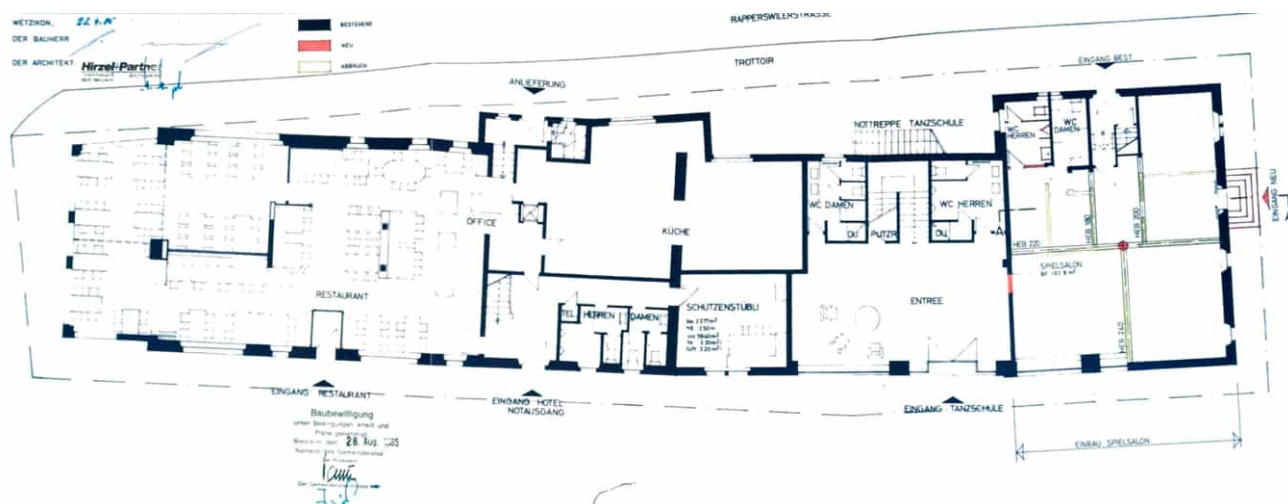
Grundriss EG, Stand 1985 (Umbauplanung Spielsalon im östlichen Kopfbau).
